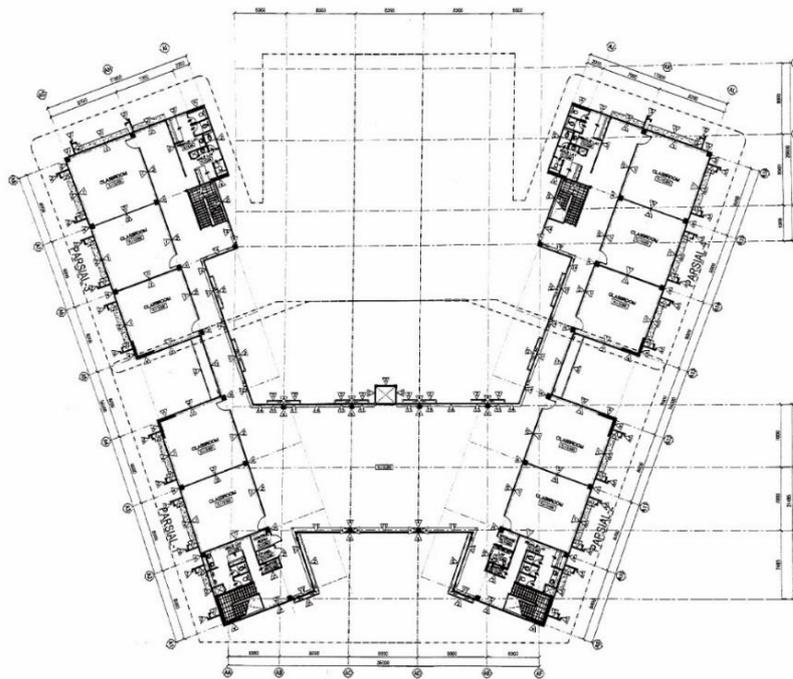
Parsial-4 Denah rencana *finishing* dinding lantai 1
